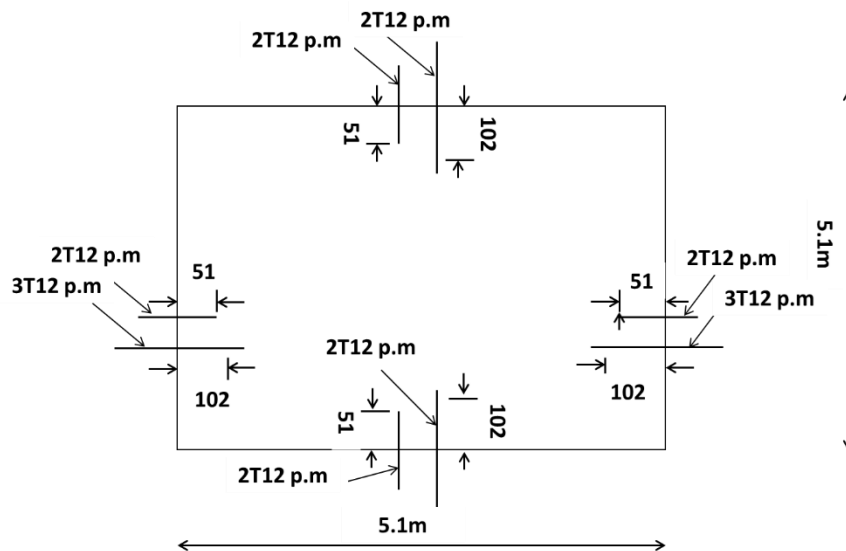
Disposition des Armatures(Sur appuis)
